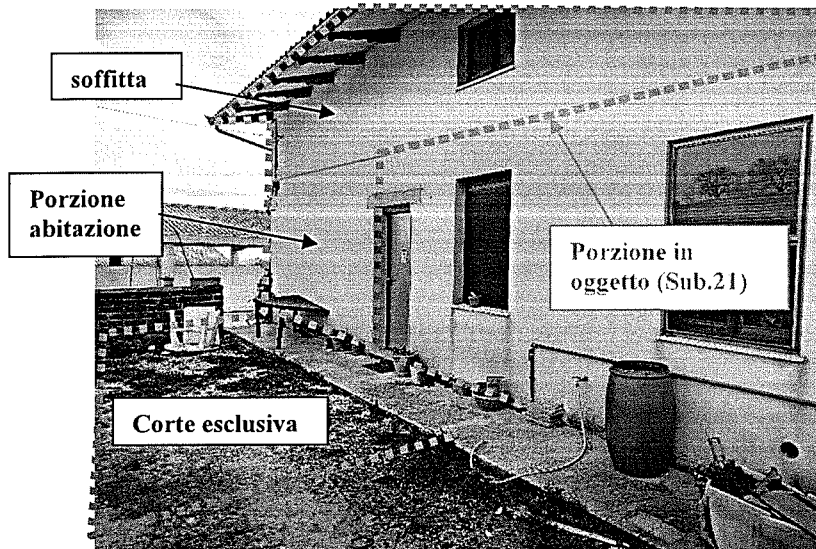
Esterno edificio con indicazione della porzione in oggetto (Sub.21)
